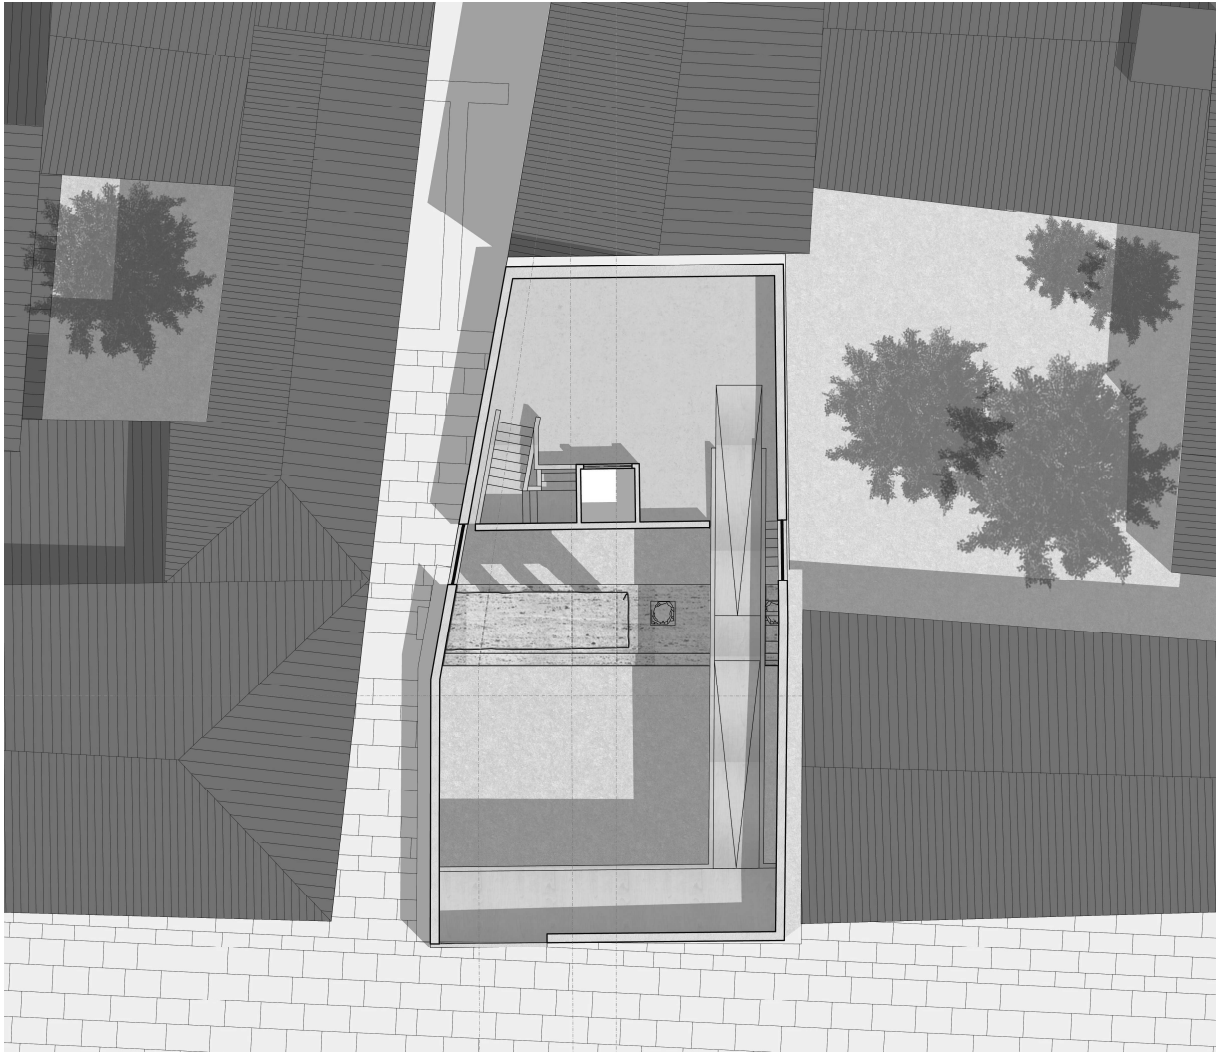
Pianta dell'edificio di Progetto in Piazza Foro
